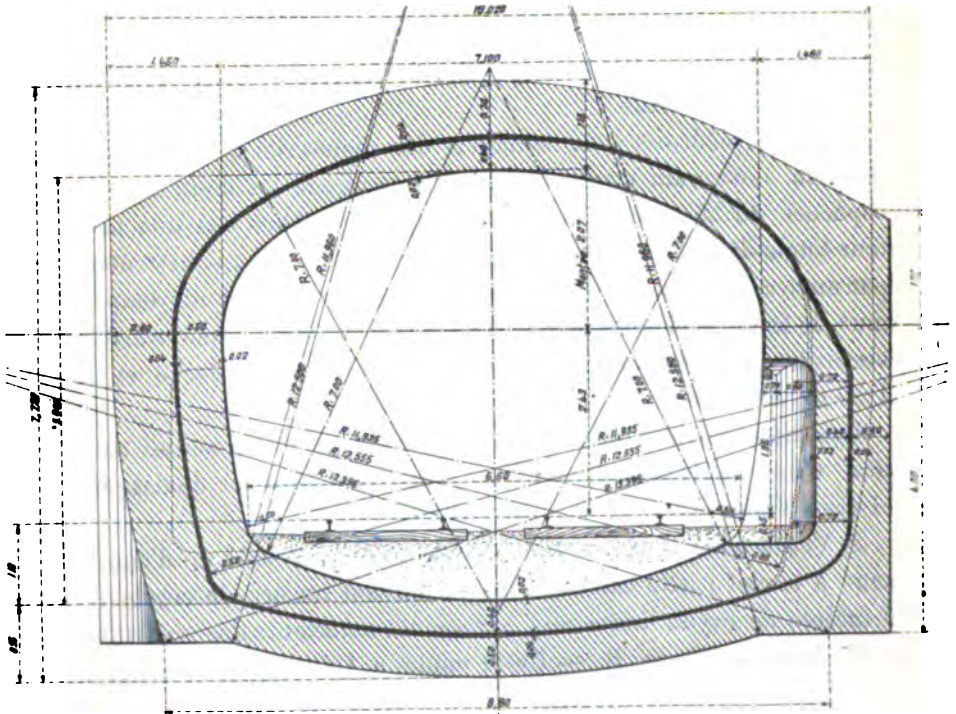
(Éch. 1/100). — Type B. Coupe transversale.
